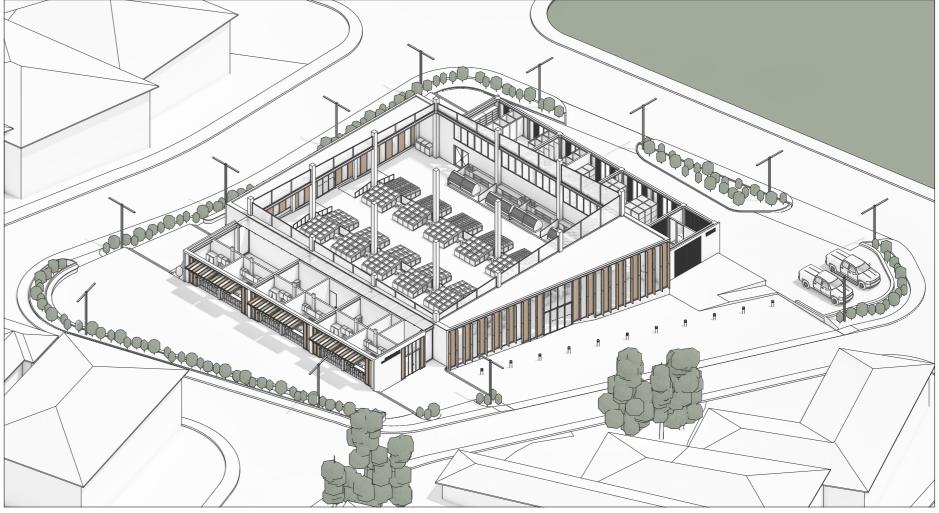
Axonometría (vista de fachada noroeste y noreste)
